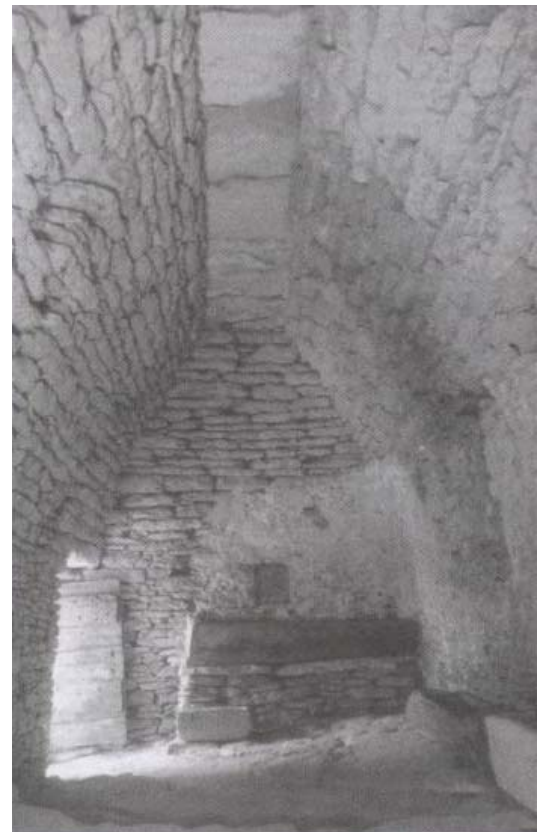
Kragkuppel-Konstruktionen ermöglichen eine ausschließlich monolithische Bauweise
